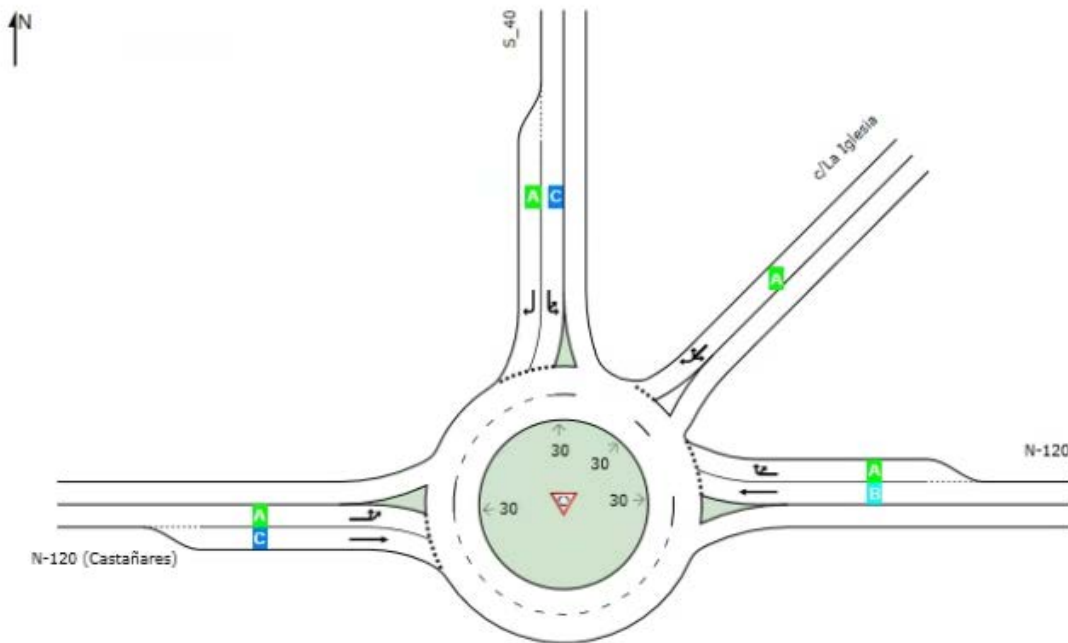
Niveles de servicio en la nueva glorieta de la N-120 en Castañares para la situación prevista
